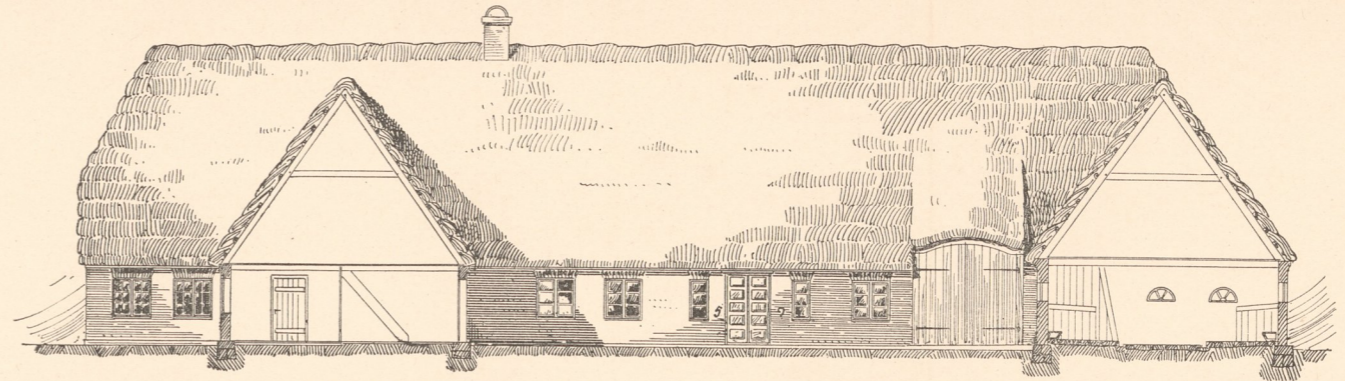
Bauernhaus in Barsmark, Kreis Apenrade. Schnitt C D.
